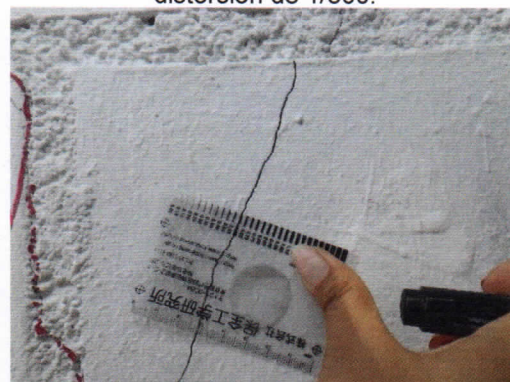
Espesor de grieta de 0.6mm en ladrillo de la cara Norte para una distorsión de 1/550.
